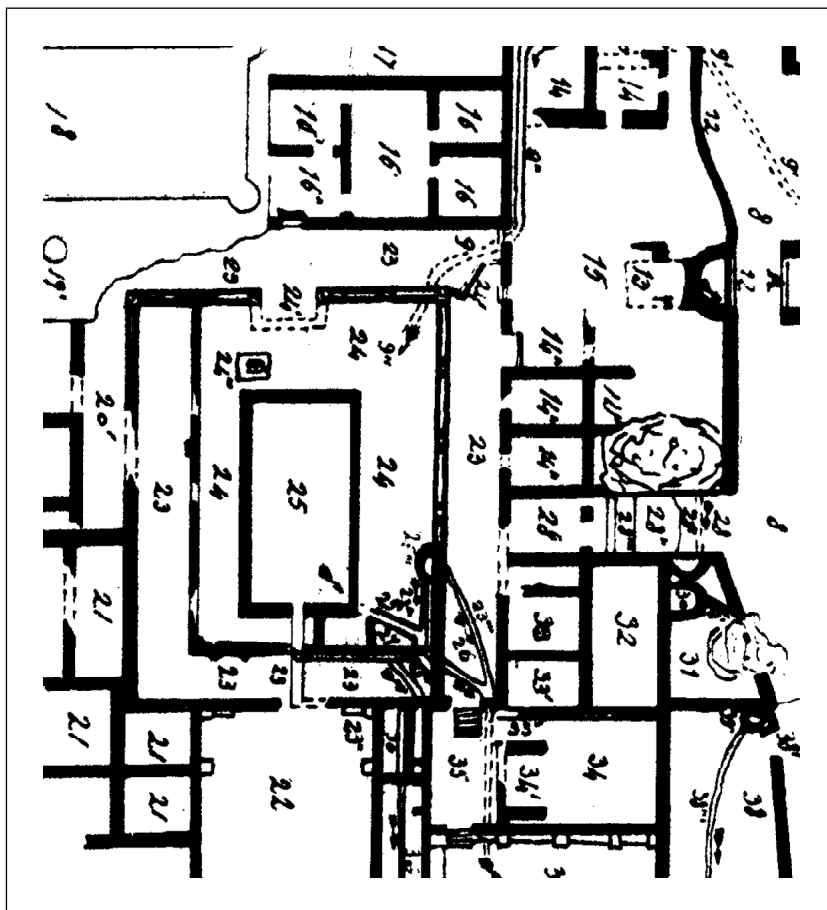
Planta que Estácio da Veiga levantou em 1877 (pormenor da zona do peristilo).
